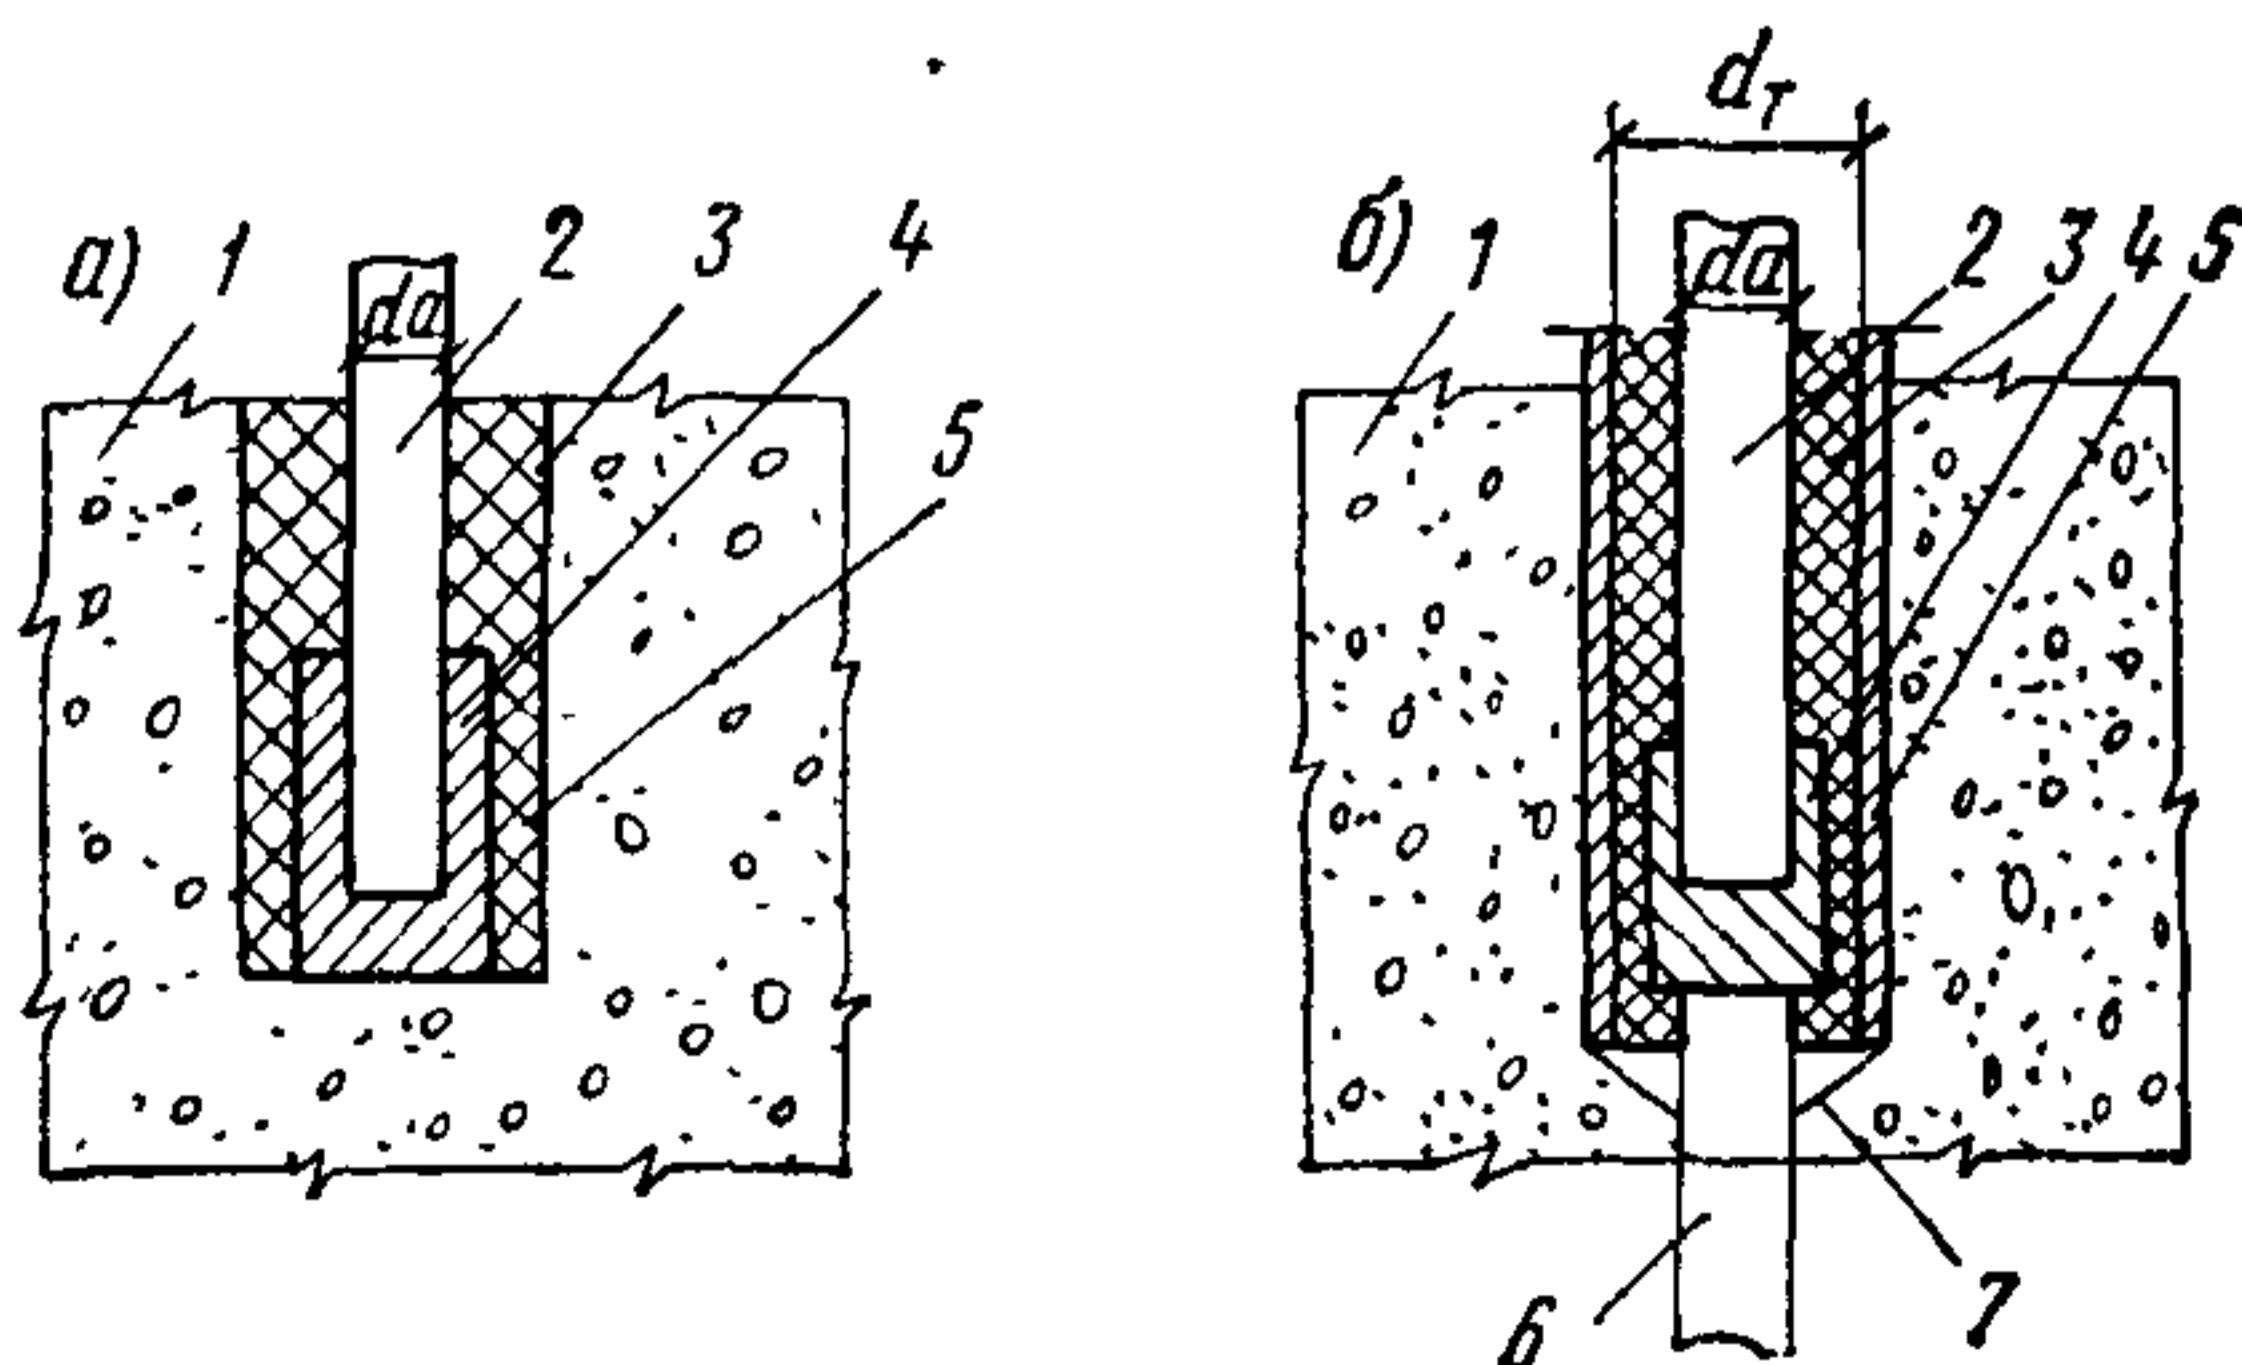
Примеры обеспечения электроизоляции анкерного стержня в стальной трубе-муфте или в бетоне
